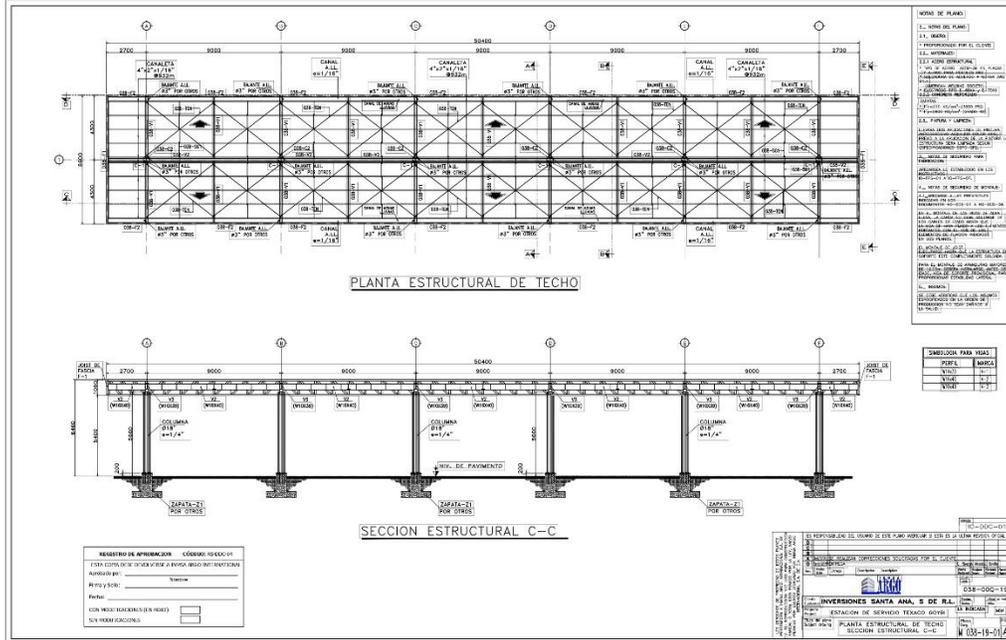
Planta estructura de techo y sección C-C, Canopy mayor
